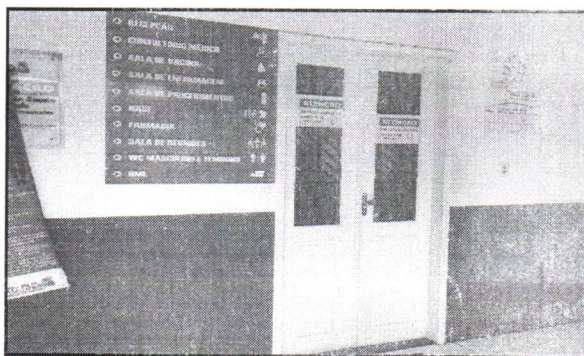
Vista da Esquadria em madeira para acesso a Recepção
